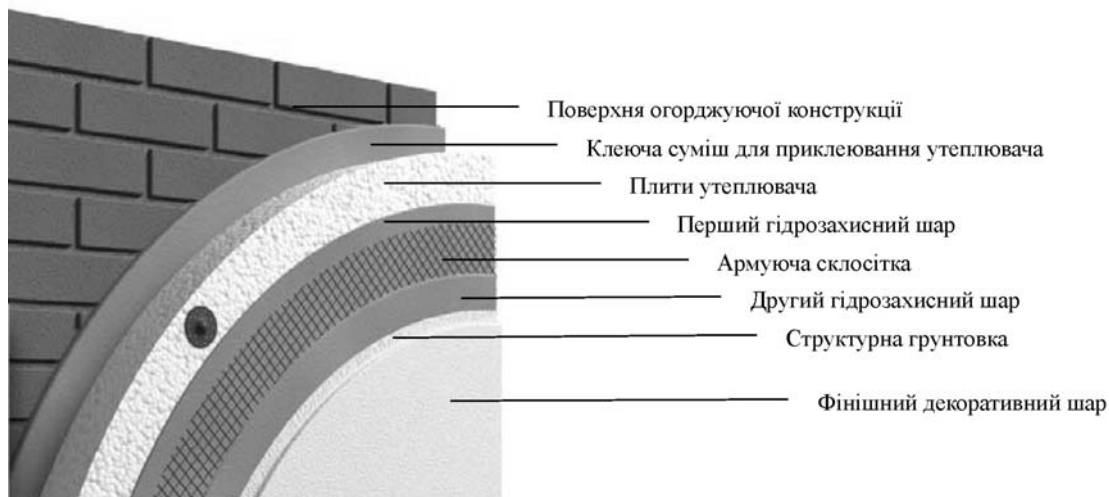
Типова схема скріпленої системи утеплення фасаду будинку
